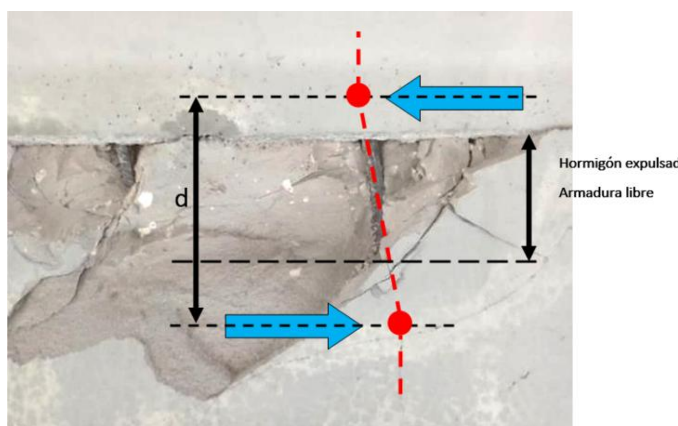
Deformación de la armadura transversal en viga 3 E-2.2. Efecto pasador de las armaduras
